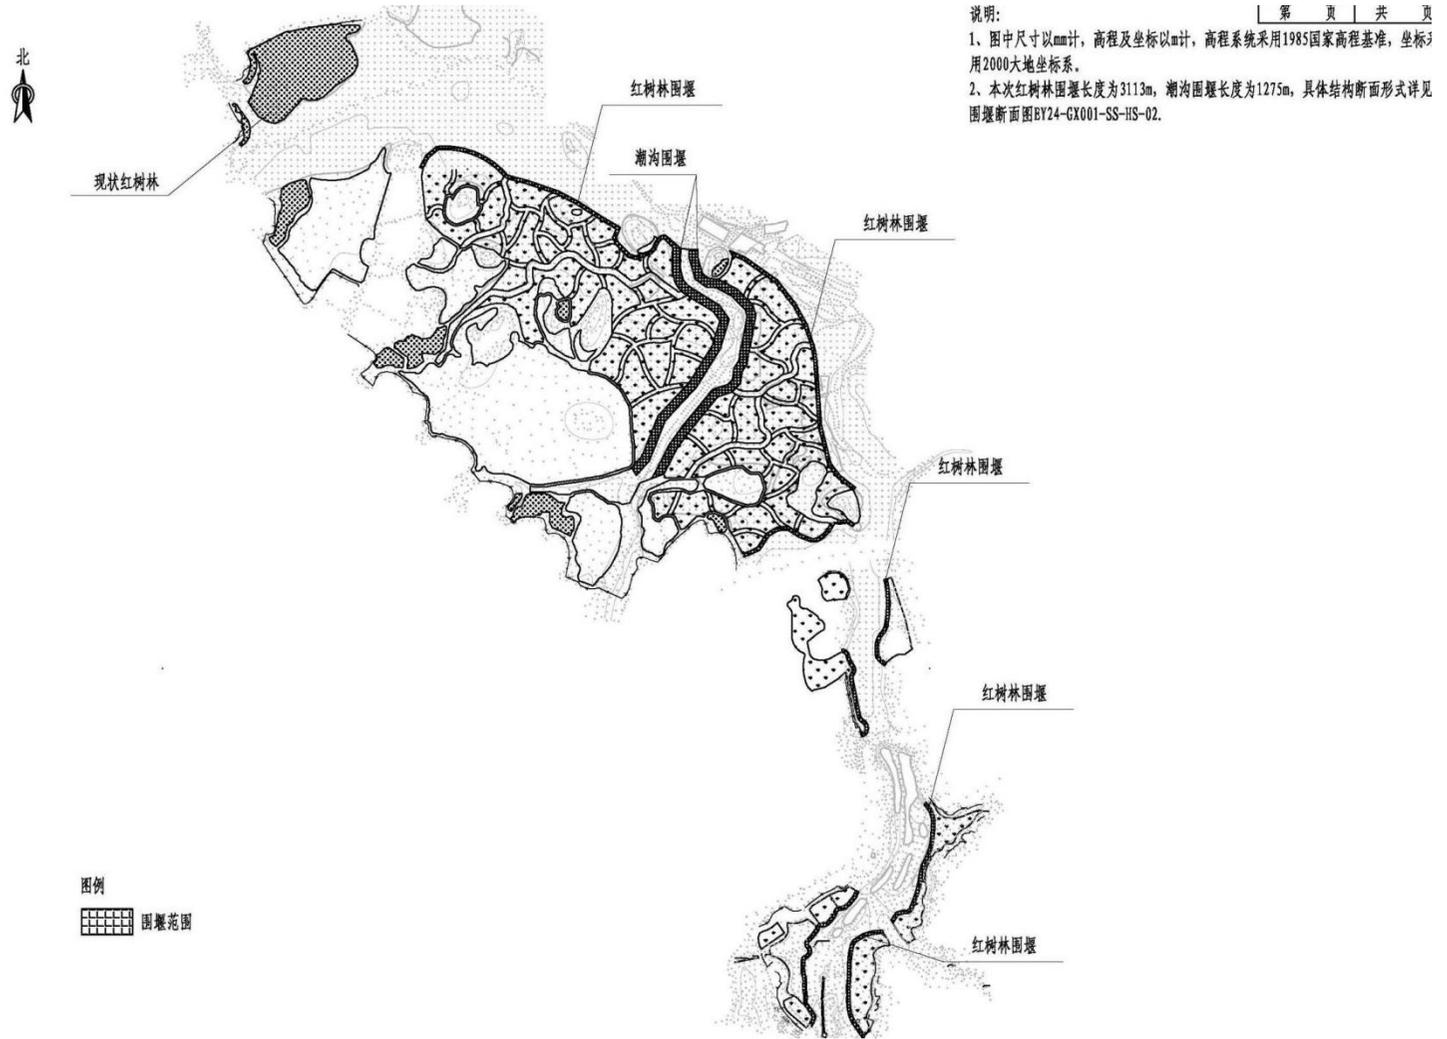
项目红树林防护带和潮沟护堤平面布置图
